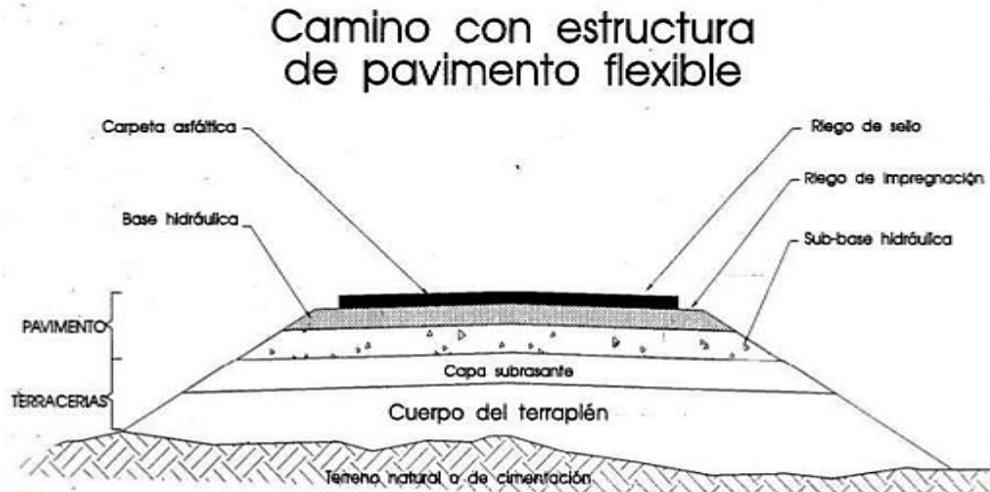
Estructura del pavimento del Camino de Acceso al Muelle.
